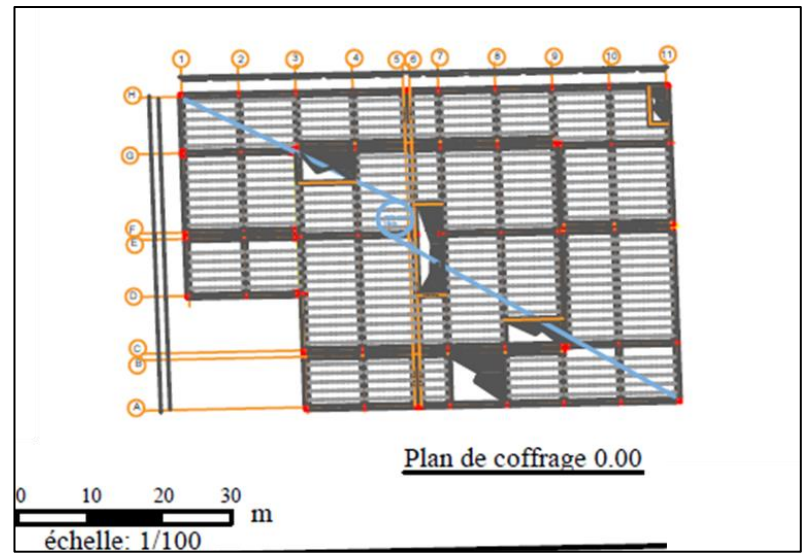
Plan de coffrage+0.00/Source : Traiter par l'auteur.
